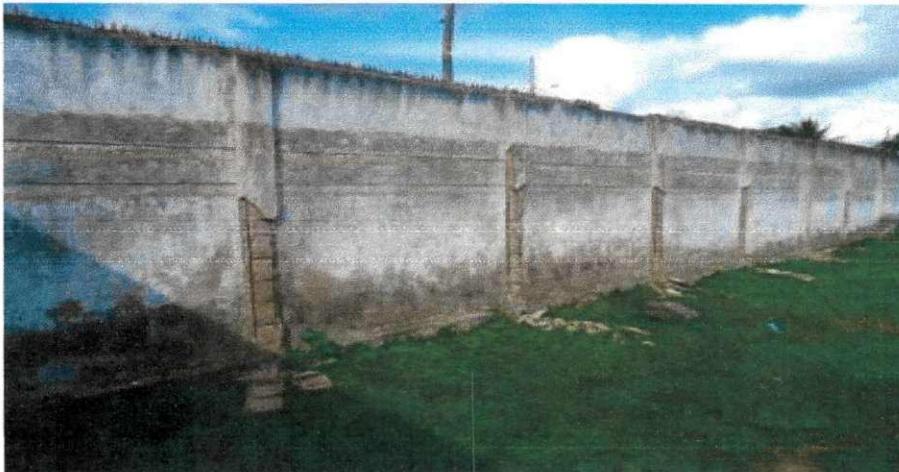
Demolição de camada de concreto para recuperação da estrutura metálica dos pilares.
